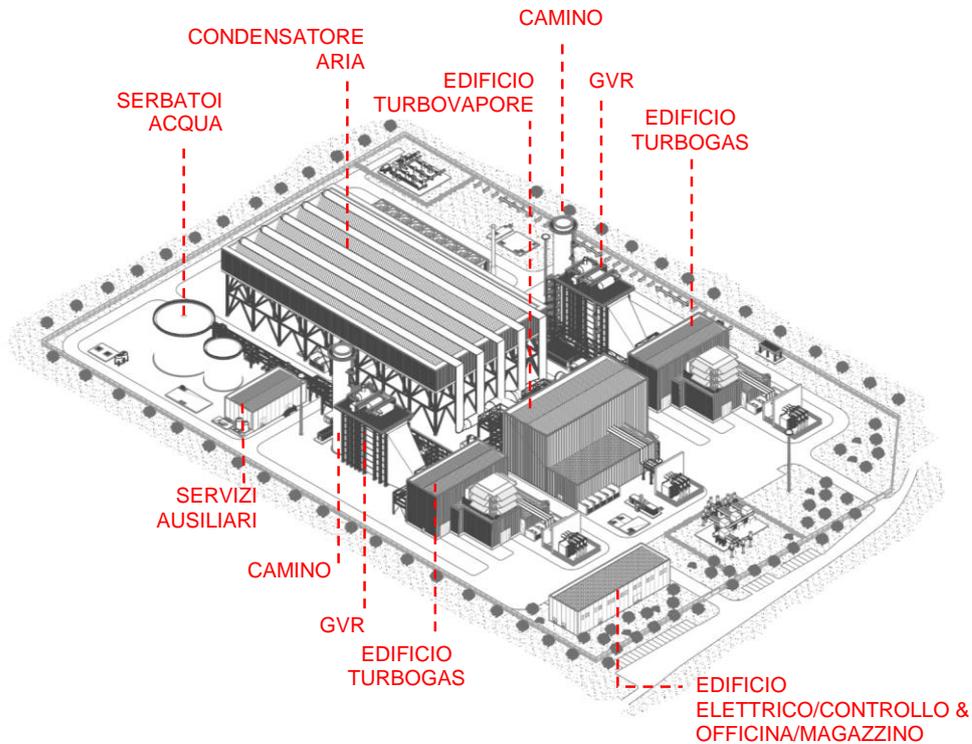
(2 di 2) Vista assometrica da Nord-Ovest – Stato di progetto
